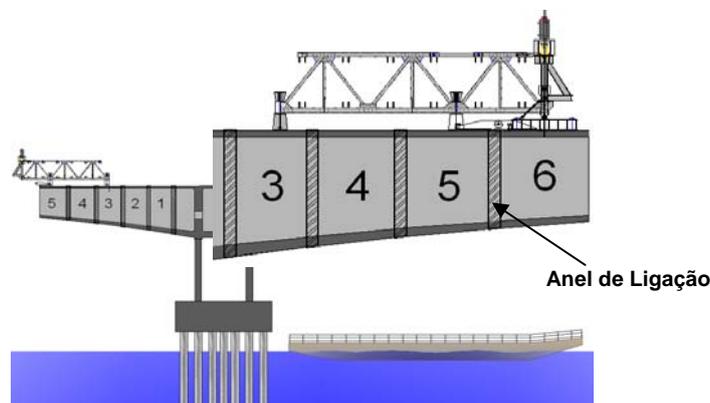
Detalhes da aduela de ligação já concretada.
